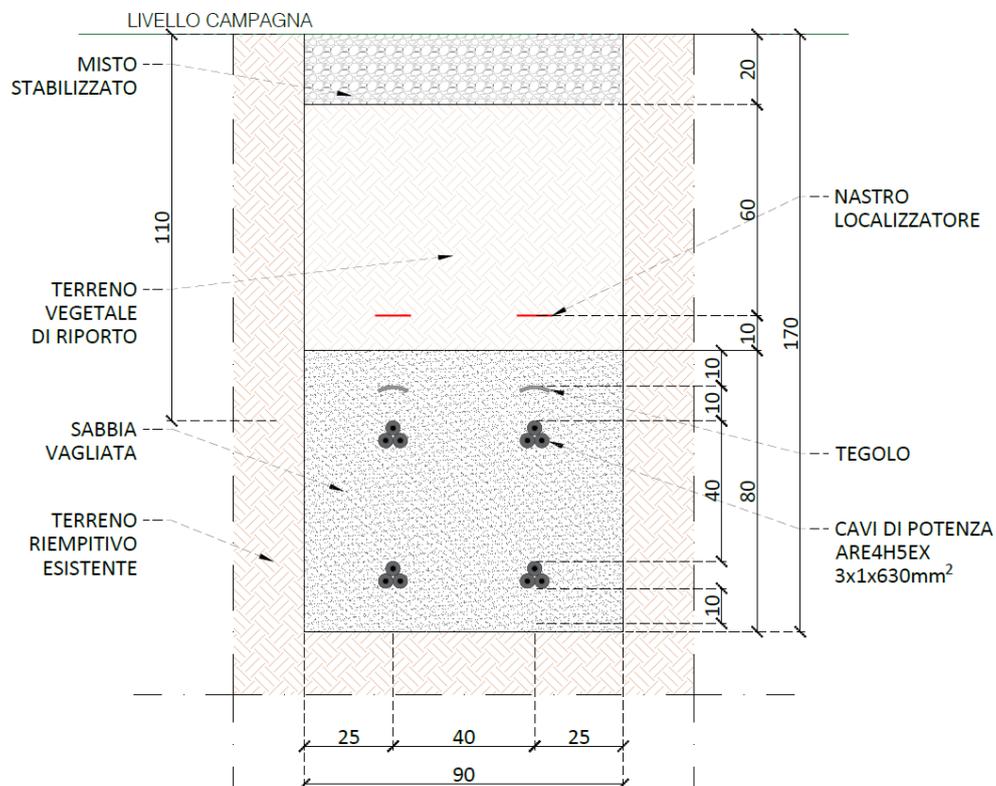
Sezione di scavo cavidotto di collegamento 30 kV 3x4x630 mm²
